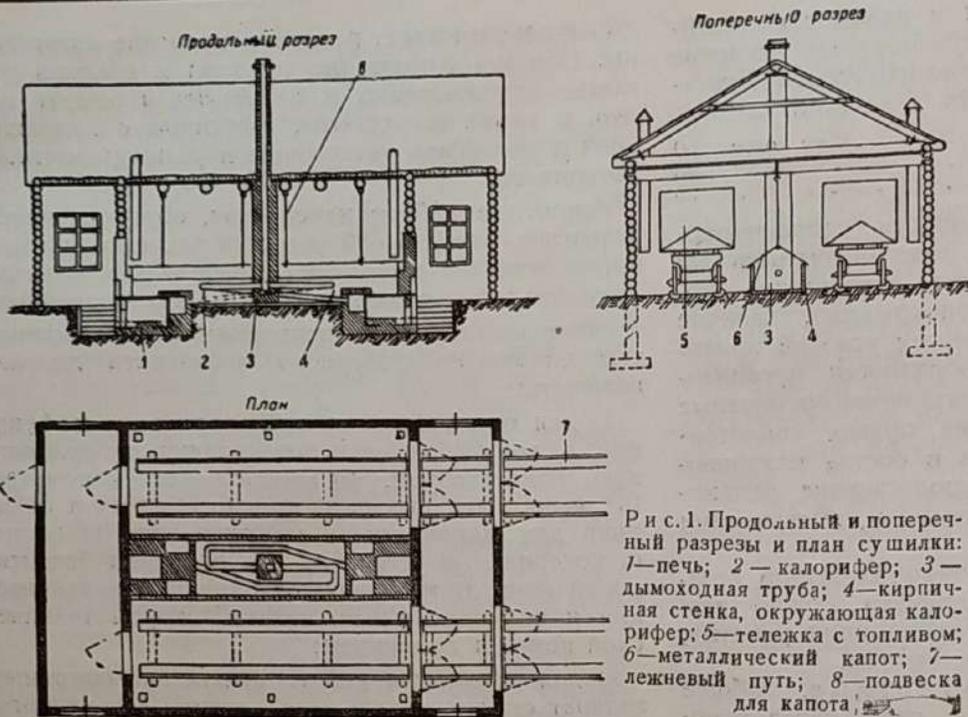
Продольный и поперечный разрезы и план сушилки: 1—печь; 2—калорифер; 3—дымоходная труба; 4—кирпичная стенка, окружающая калорифер; 5—тележка с топливом; 6—металлический капот; 7—лежневый путь; 8—подвеска для капота.
